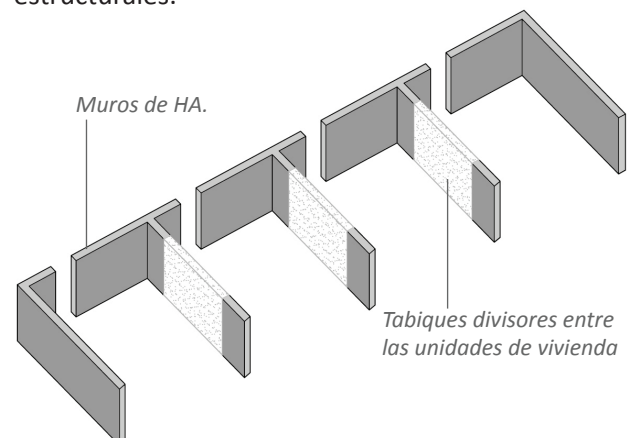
Esquema de sistema estructural. Elaboración propia.
